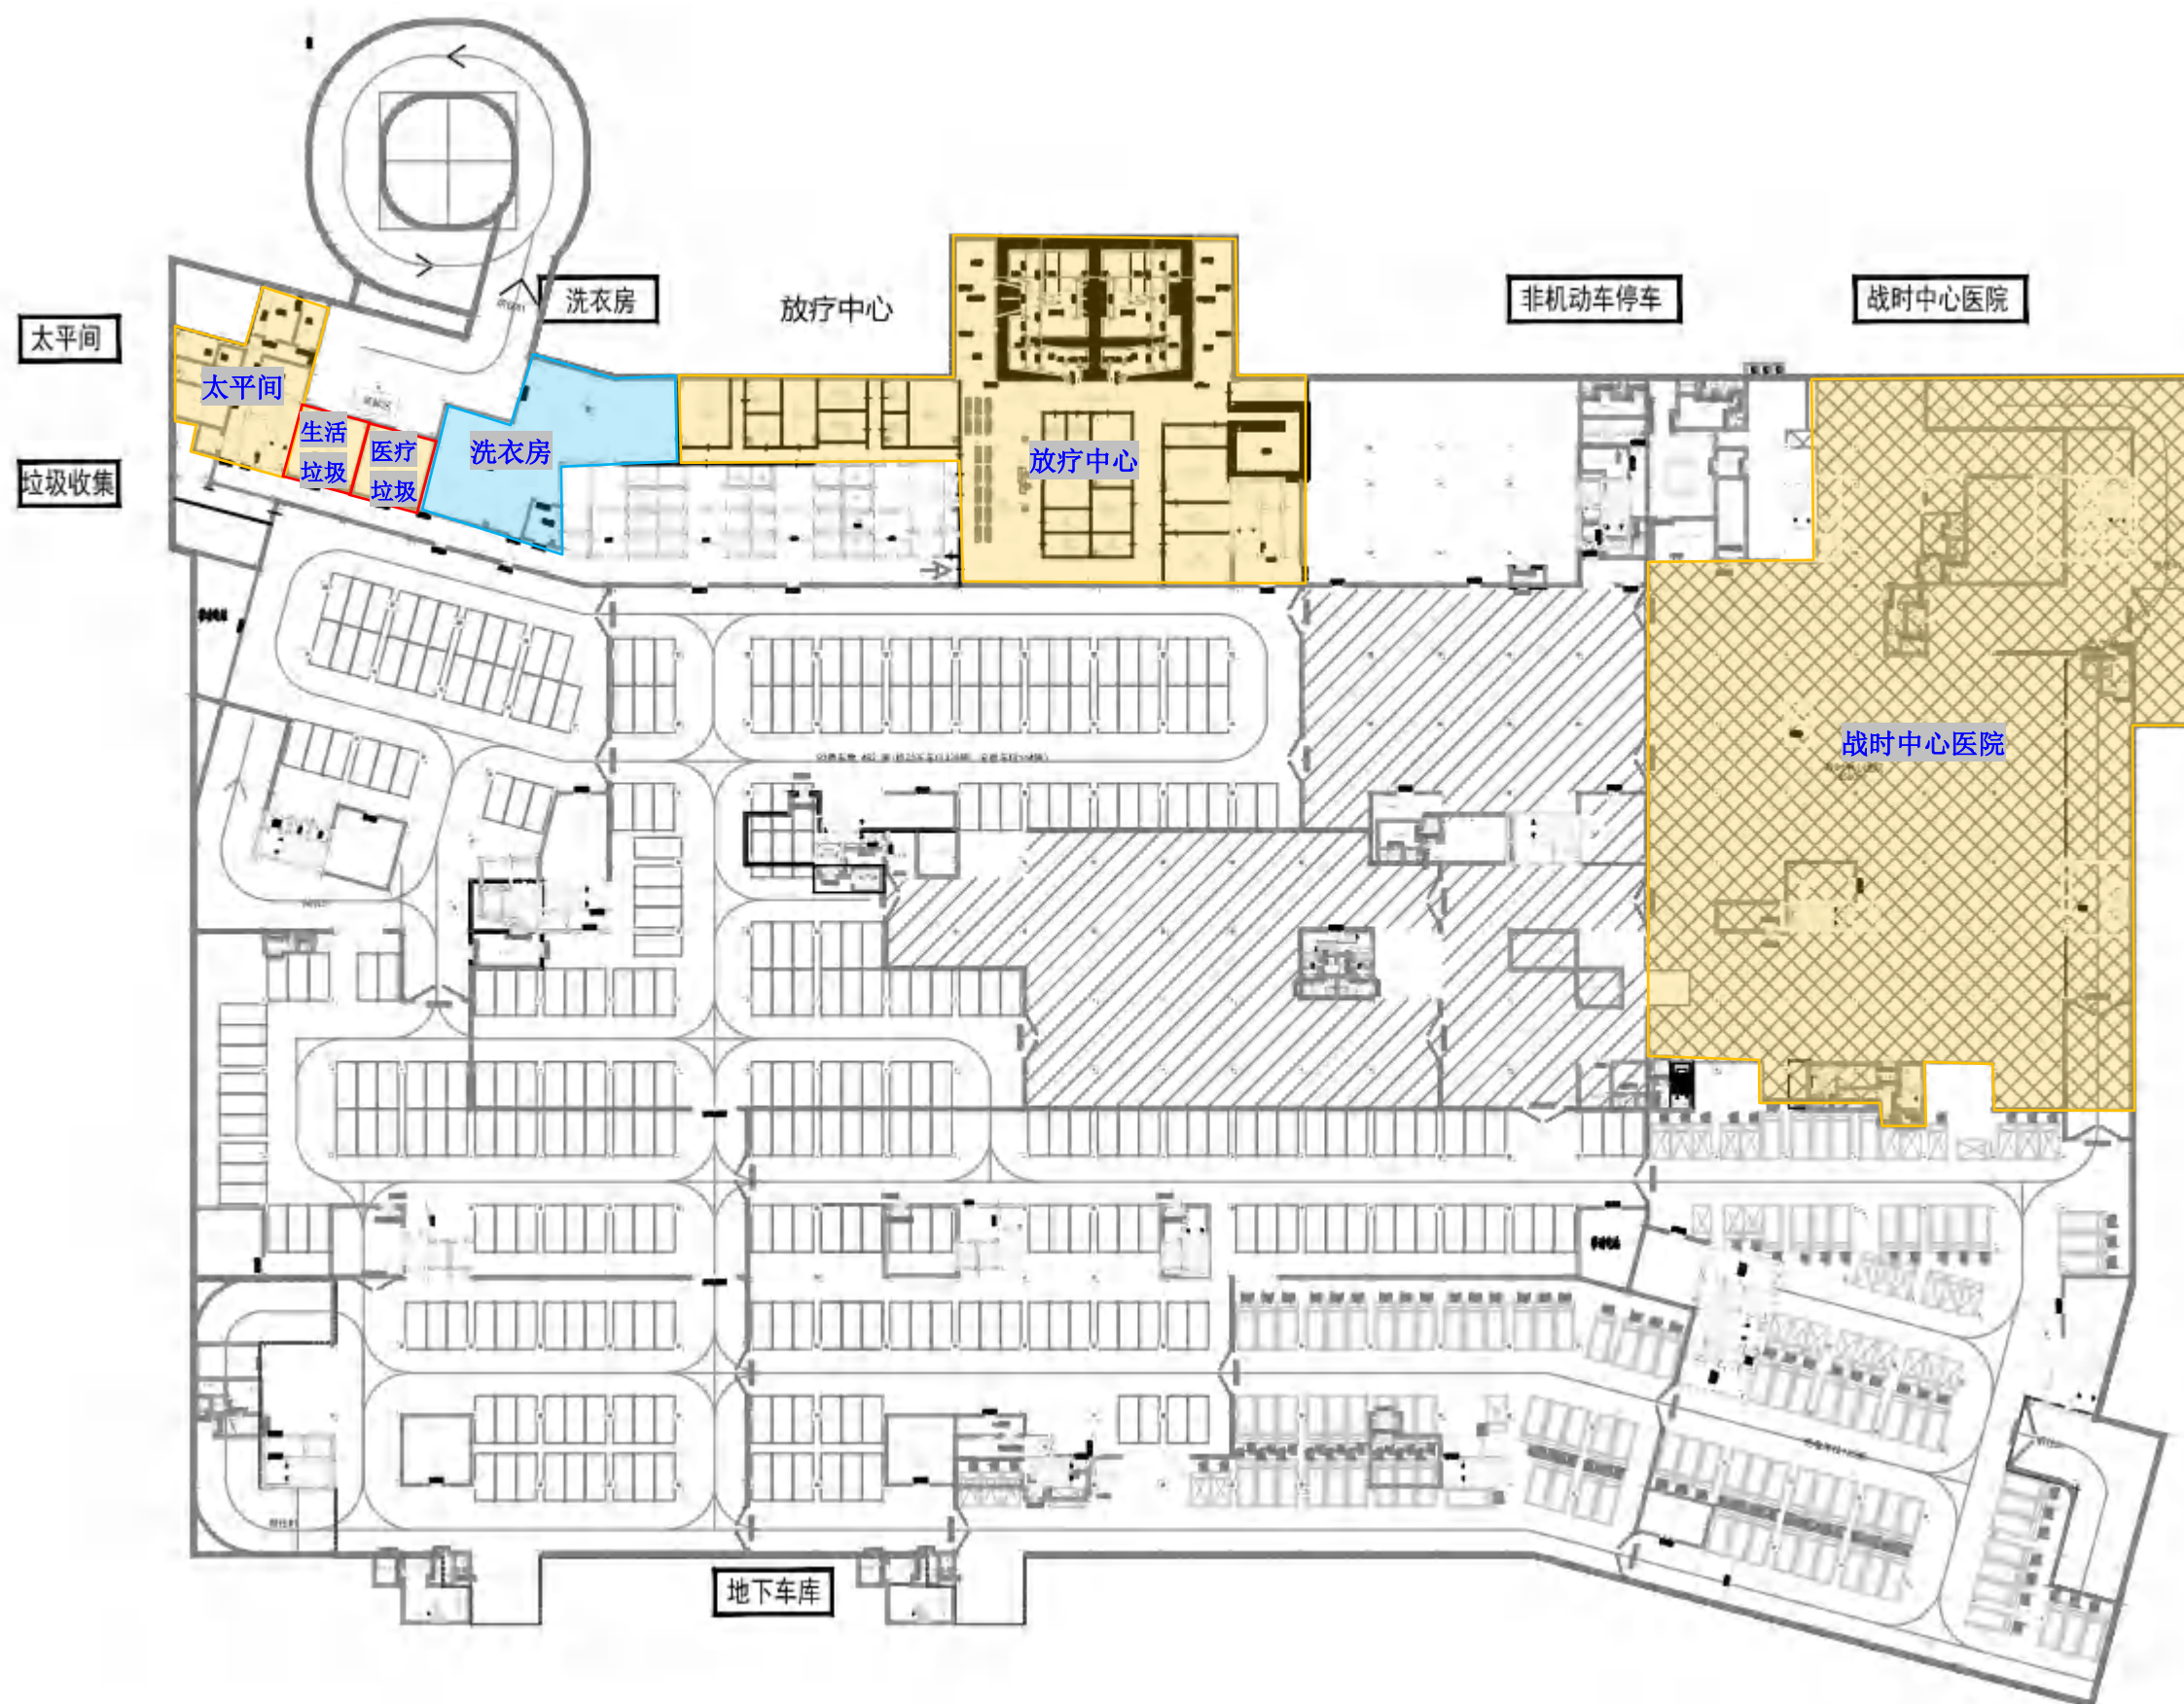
项目医疗综合楼地下负二层平面布置图（比例尺：1464）
